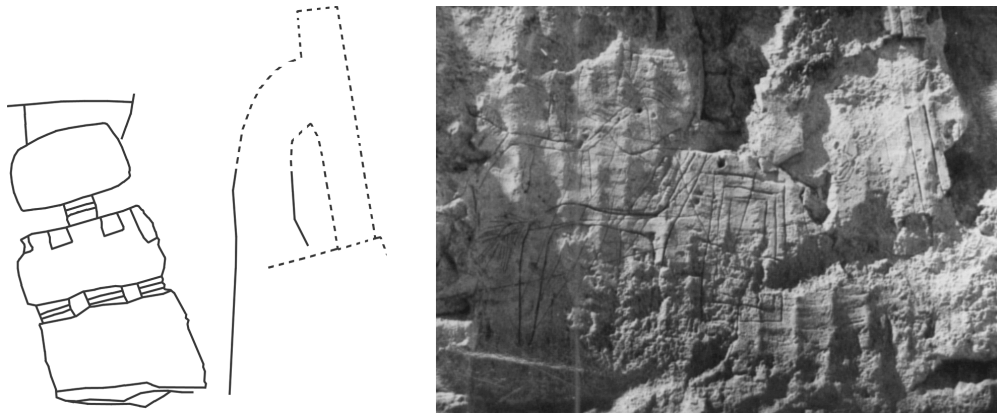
L'église B2 : a) Plan ; b) Détail de la paroi ouest du *naos*.
